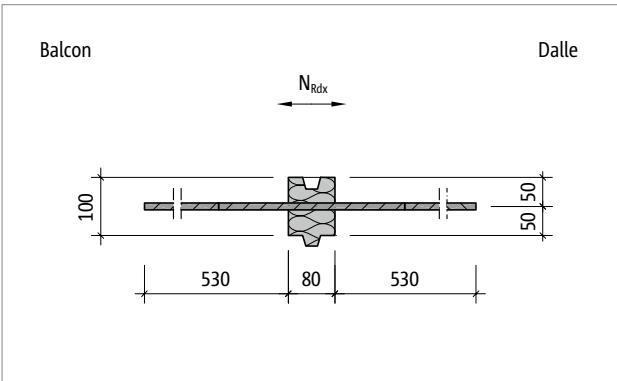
Schöck Isokorb® T Type H-NN2 : Plan de base du produit
